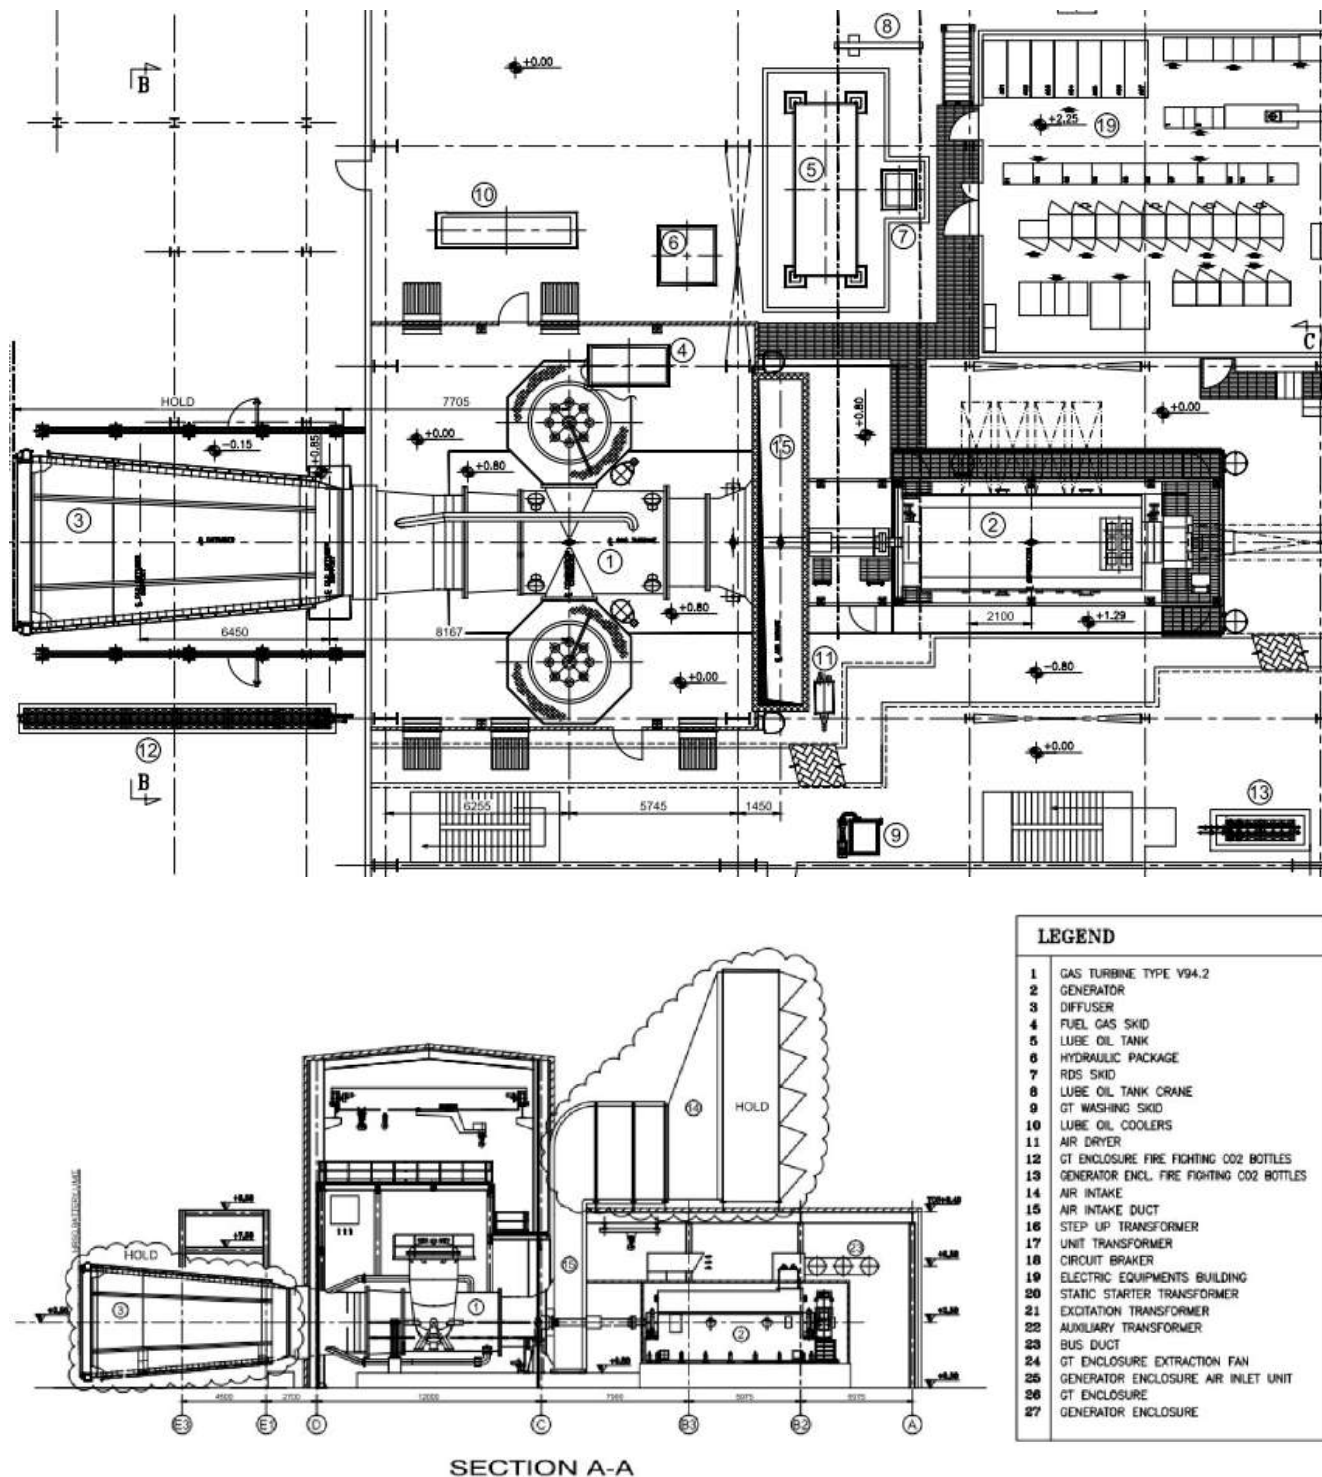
Nuova TGI, alternatore ed ausiliari – layout e sezione
